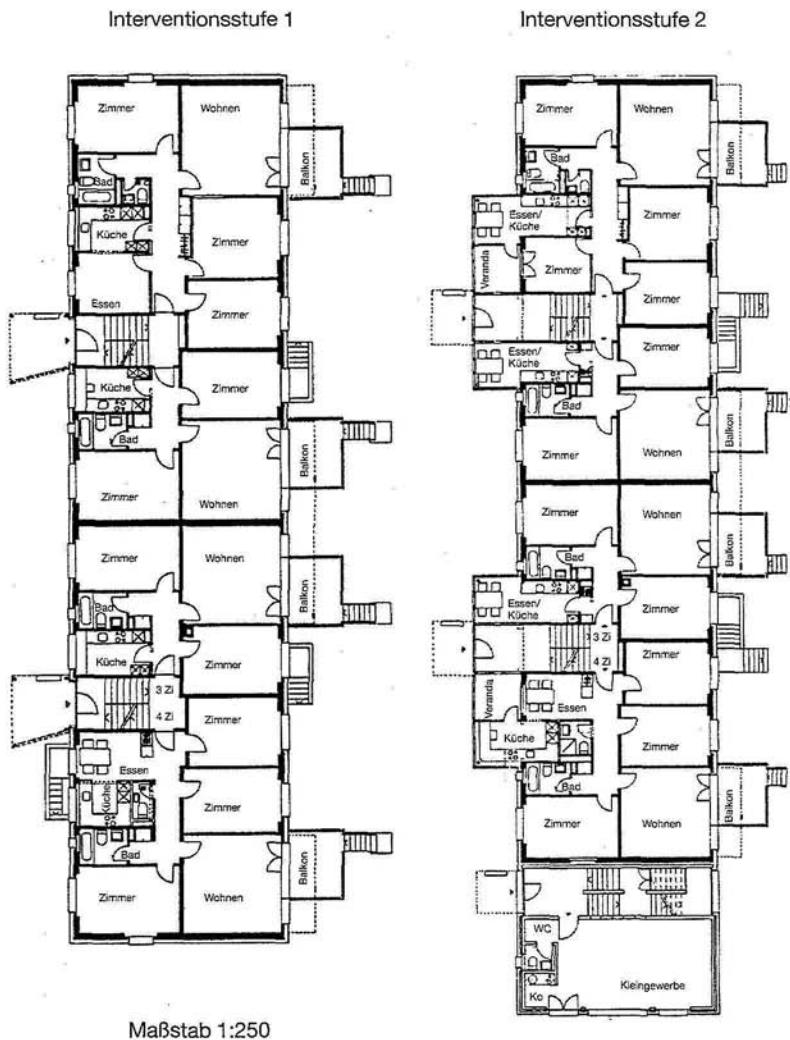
Grundriß Erdgeschoß nach der Sanierung
